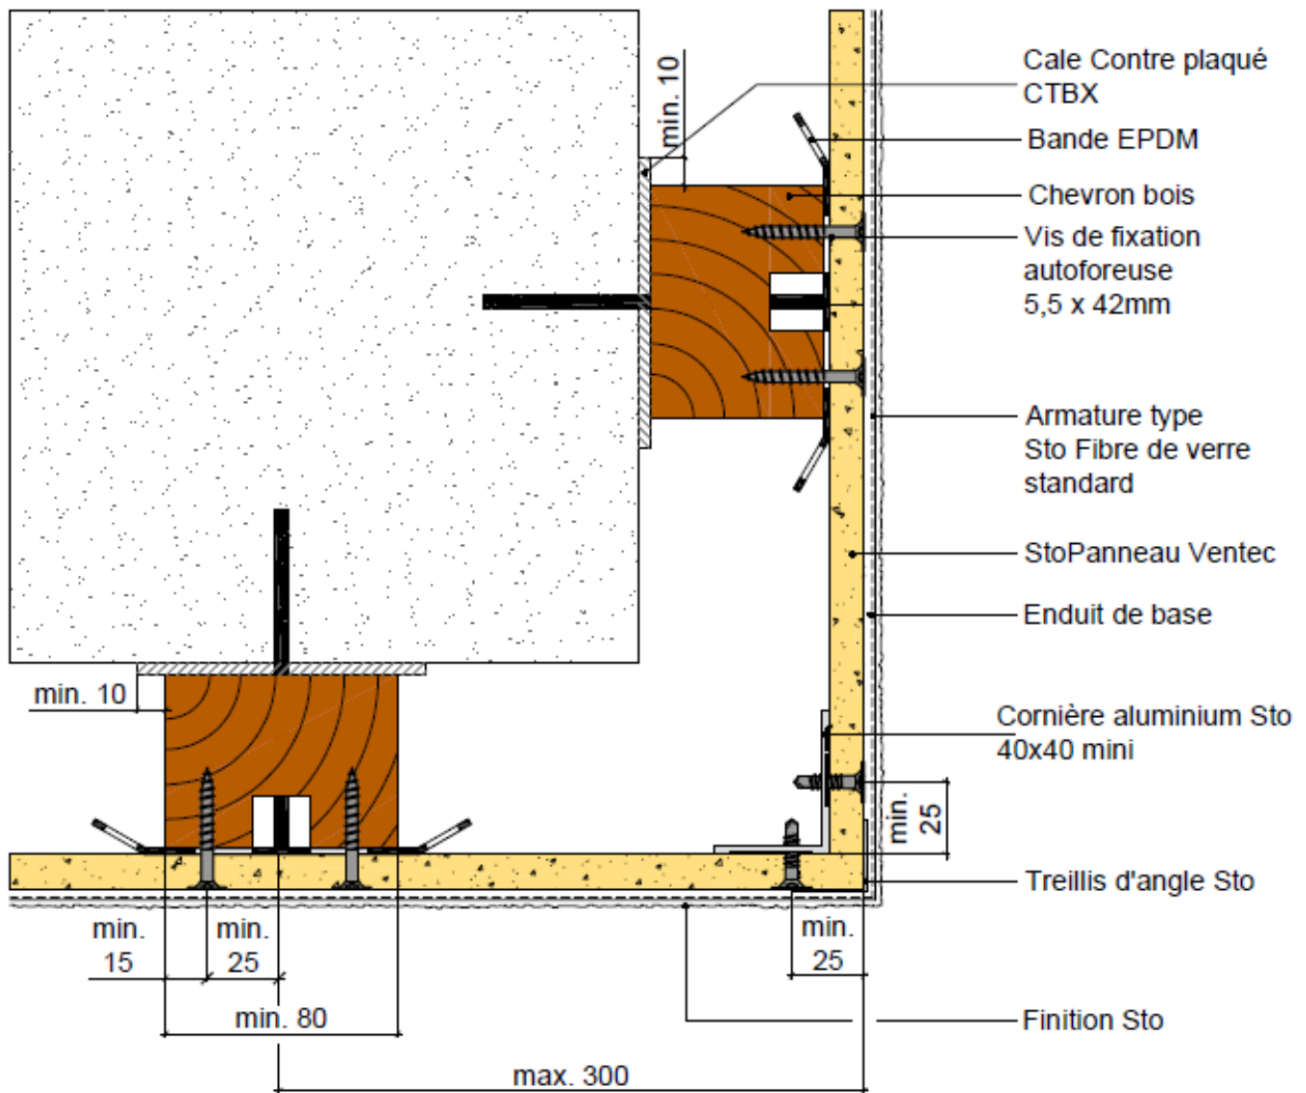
Coupe horizontale - Angle sortant - Pose directe sur support béton
